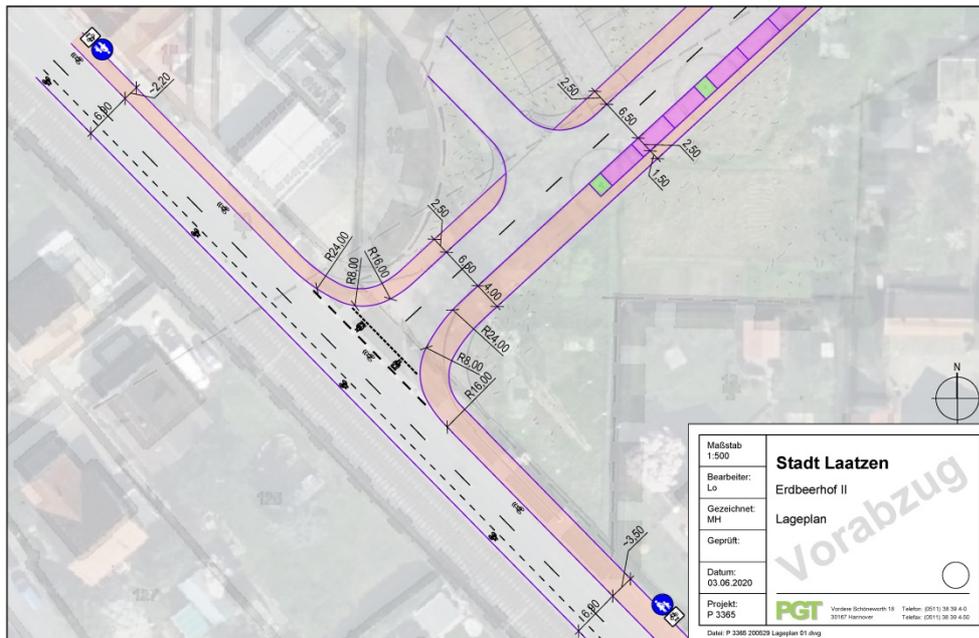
Skizze Knotenpunkt Planstraße A / Hildesheimer Straße
